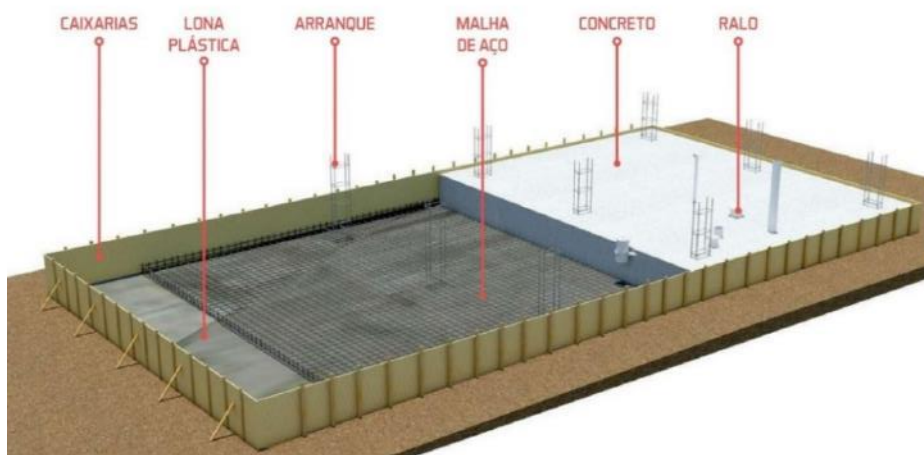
Componentes do Radier em Concreto Armado. Fonte: O Guia..., 2017?, p.8
